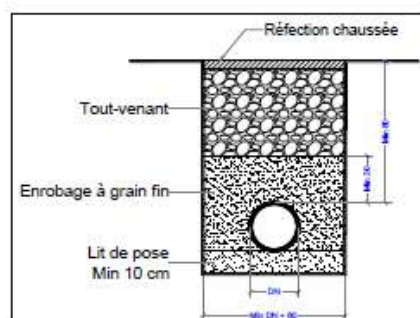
Schéma d'une tranchée type (d'après APS rapport N°2).
